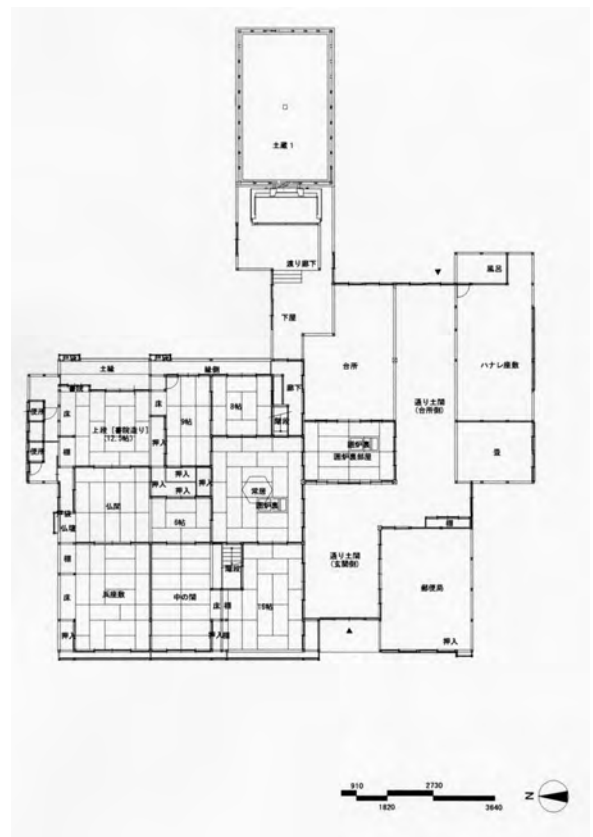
佐藤家住宅 1 階平面図（製図：西川浩子）
